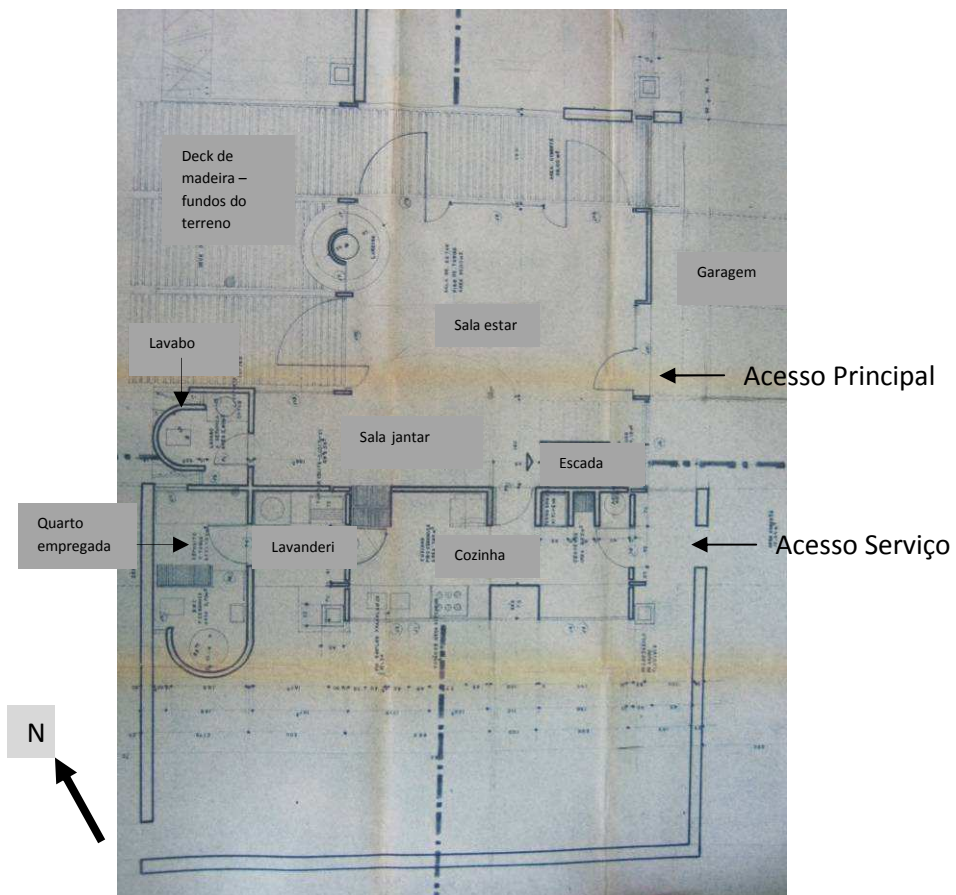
Residência Othelo Lopes Filho: Planta do pavimento térreo
